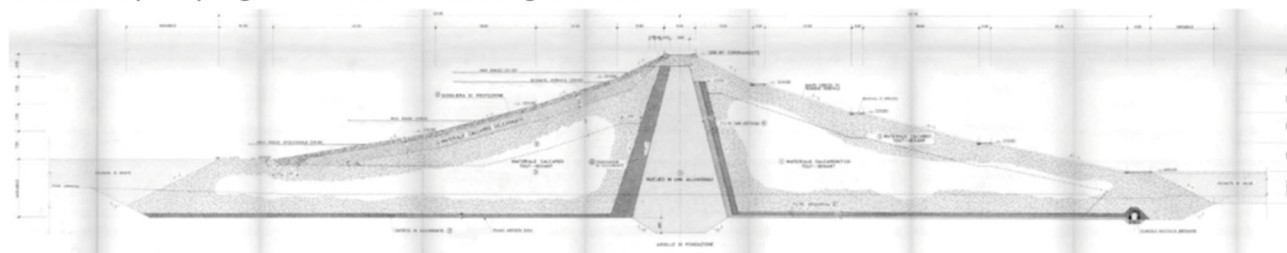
Confronto tra la sezione tipo prevista dal progetto di massima 1969 e quella definita dal progetto esecutivo di adeguamento del 1983
